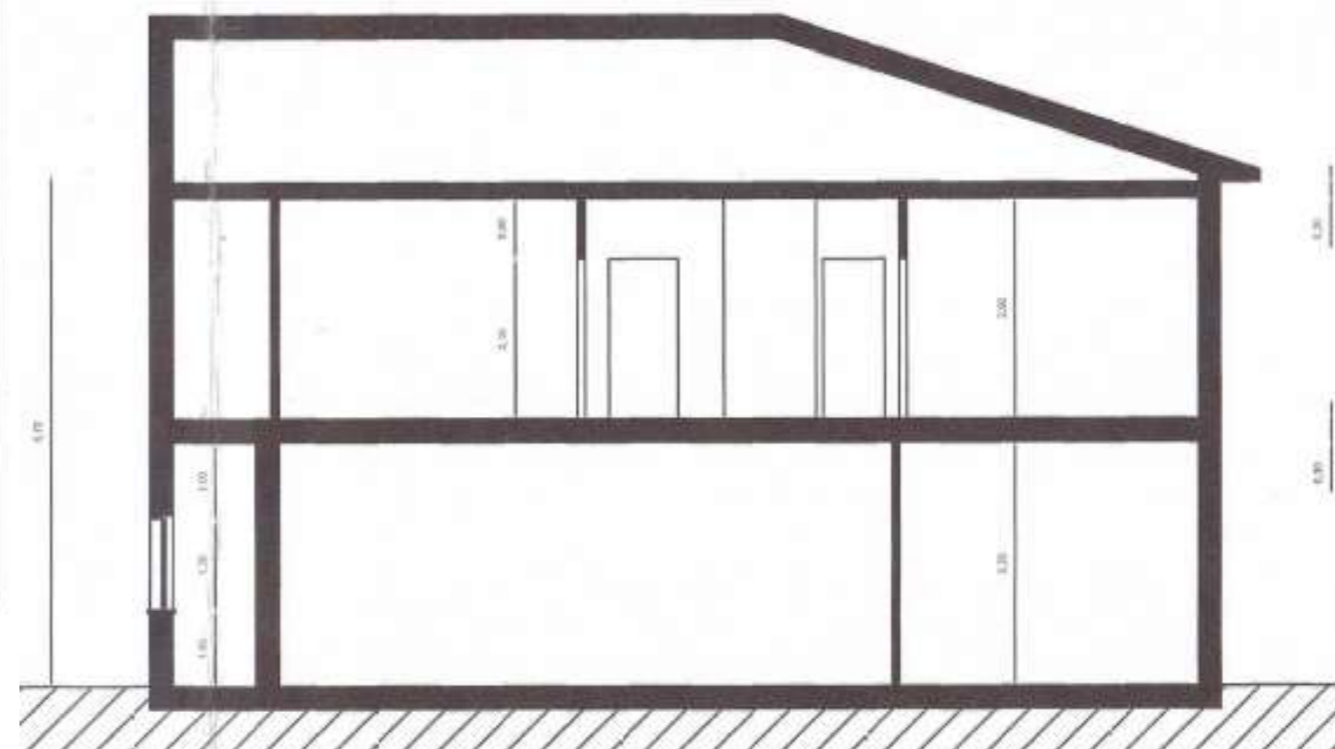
Stralcio elaborato progettuale Permesso di Costruire n.22/2008 del 22/04/2008
